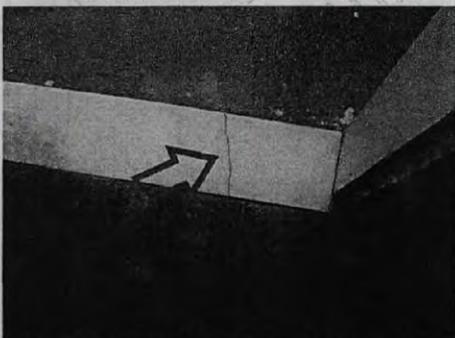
Sala: soleira trincada; Foto 13 – Afastamento dos fundos: vista parcial do afastamento dos fundos; Foto 14 – Idem: vista parcial do afastamento dos fundos – outro ângulo;
